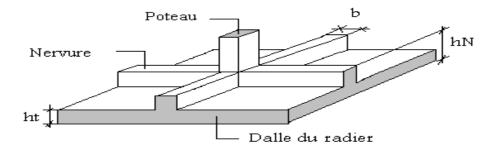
Disposition des nervures par rapport à la dalle et aux poteaux
